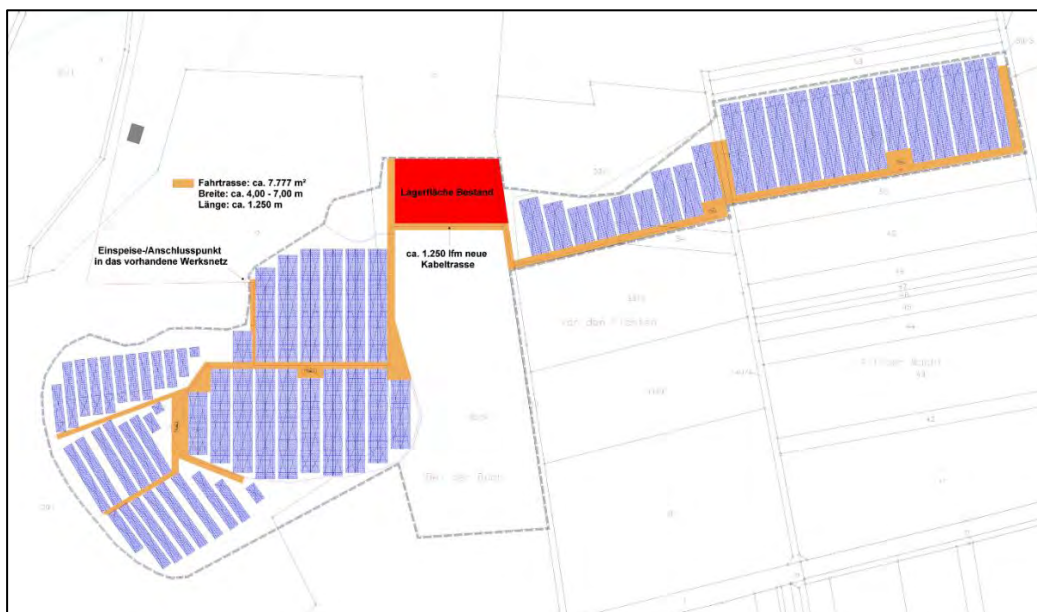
Vorläufiger Belegungsplan Geltungsbereich 2 mit Darstellung Lagerflächen (rot) und Fahrtrassen (gelb), Quelle: IDA (2024)
